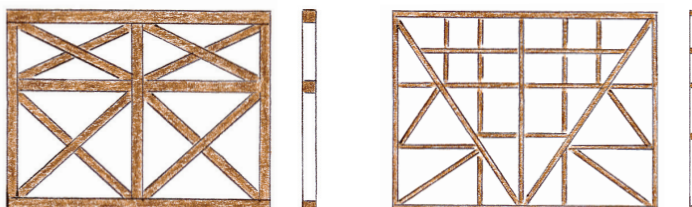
Elévations et sections : a) Ossature en bois de section épaisse avec remplissage en maçonnerie ; b) Ossature en bois de section réduite avec remplissage.
